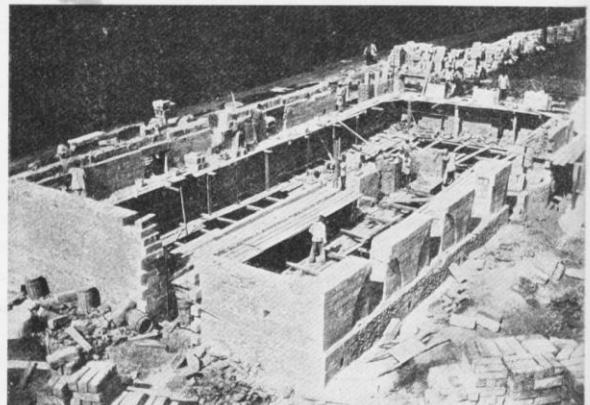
Подвалъ Станціи. Въ общемъ котлованѣ, глубиной до 3 саж., вырытомъ въ каменистомъ известковомъ грунте, идутъ каменные работы по возведению столбовъ, на которыхъ будуть выложены наружные стѣны подвала. Въ центрѣ снимка видна работа арки изъ кирпича на цементномъ растворѣ, перекрывающей правый пролетъ между угловыми и средними столбами. Слѣва, на продольной стѣнѣ, по аркамъ между столбами, уже выведена сплошная стѣна изъ дикарного камня до паза для желѣзо-бетонного перекрытия. На переднемъ планѣ снимка — кучи „ликаря“, извлеченного изъ выемки; за котлованомъ штабели штучнаго камня — „пятерика“ изъ одесскихъ городскихъ каменоломенъ, а вправо и вдаль отъ штабелей — виноградникъ Станціи.
